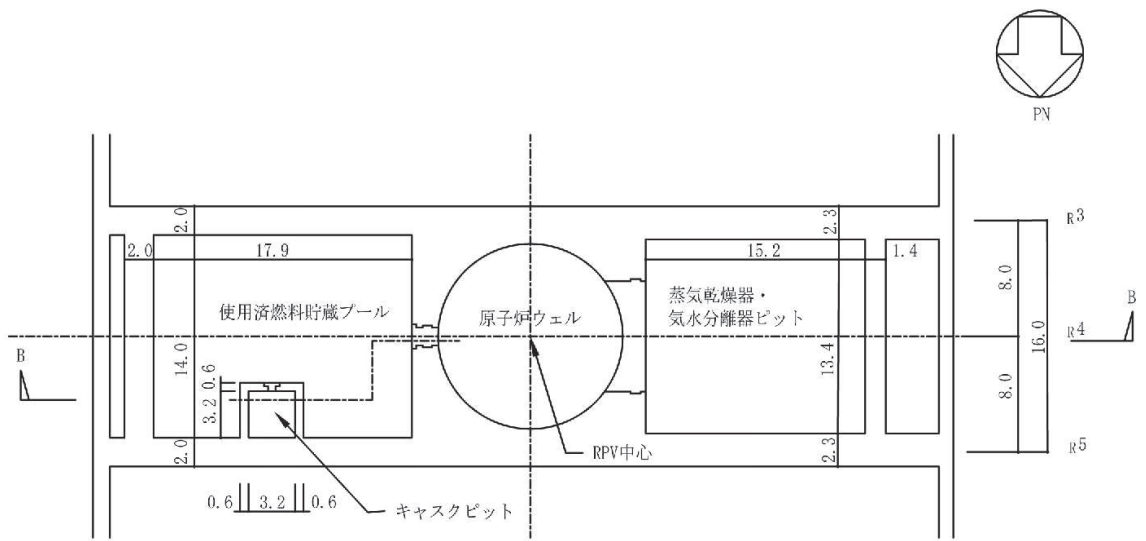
使用済燃料プール周りの概略平面図（単位：m）
